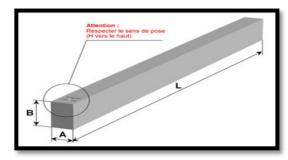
Une poutre. Source : Disponible sur : http://www.robert-thebault.fr/poutres-prefabriquees-2-4-0-148.php (Consulté le 20/12/2016).
